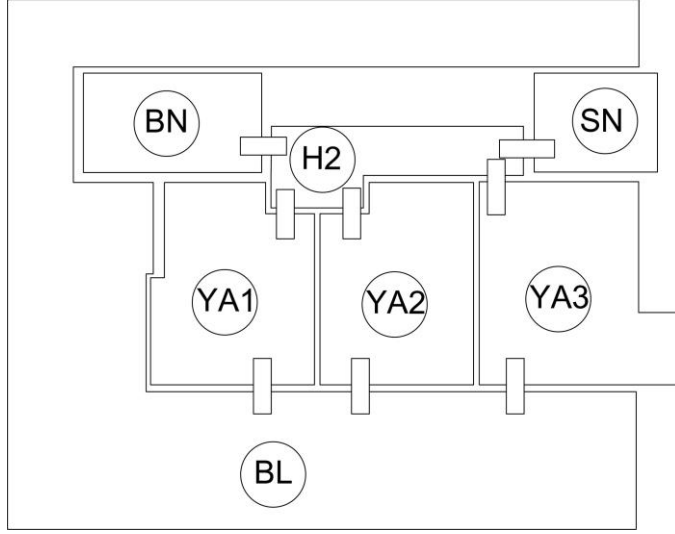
Safyurtlu II Köşkü giriş kat planı
